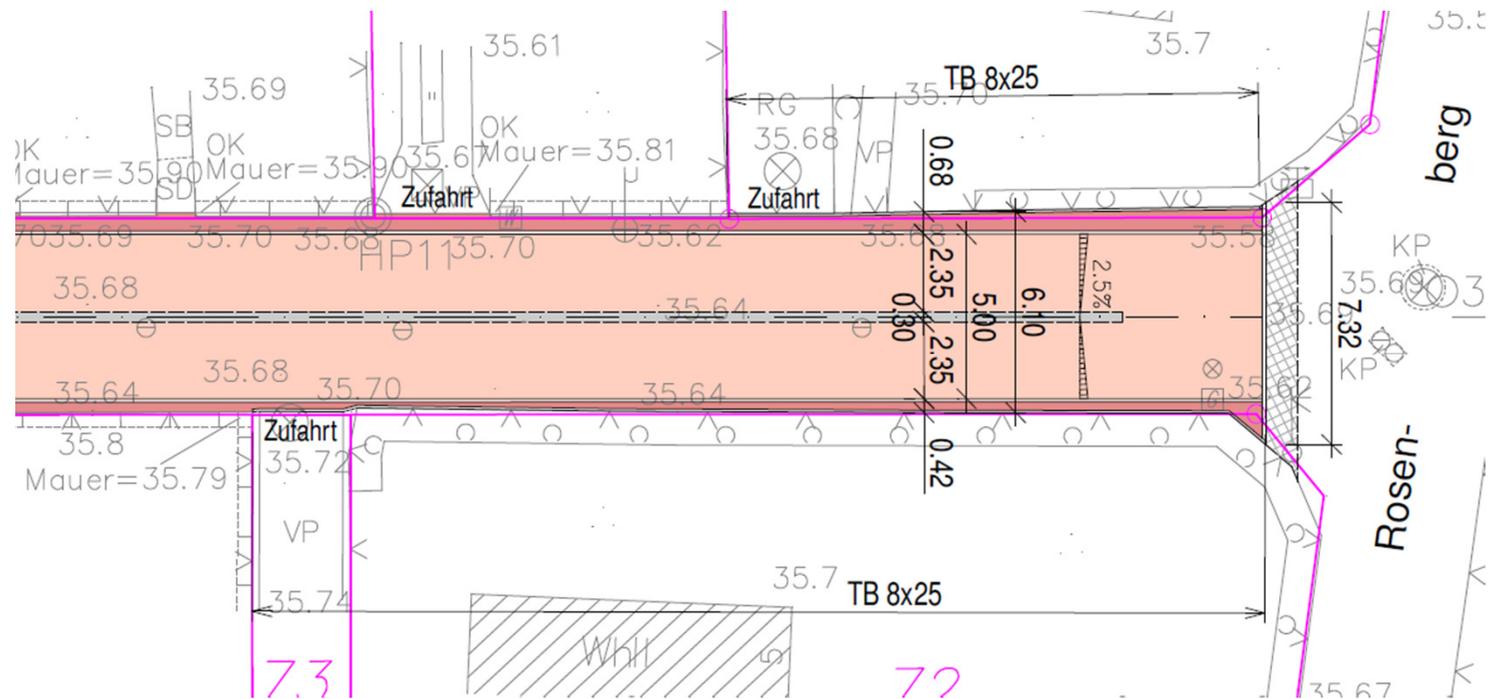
Lageplanausschnitt Vorzugsvariante mit 5,00 m Fahrbahnbreite
